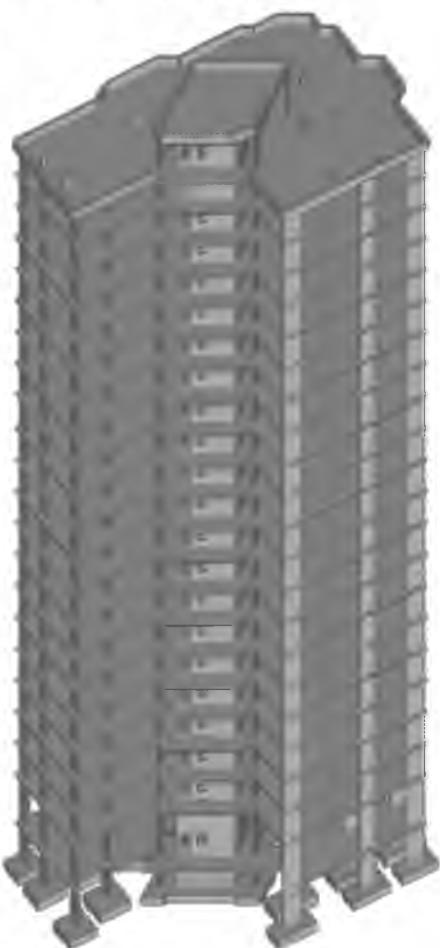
3D модель каркасу будівлі Рис. 3.2. Розрахункова схема каркасу будівлі
